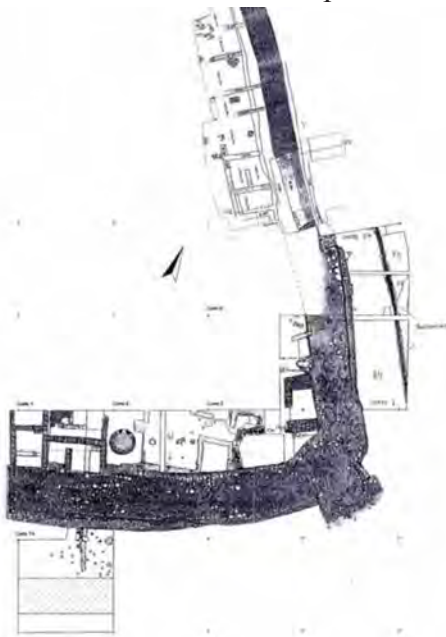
Planta de los sectores excavados de la Fonteta
